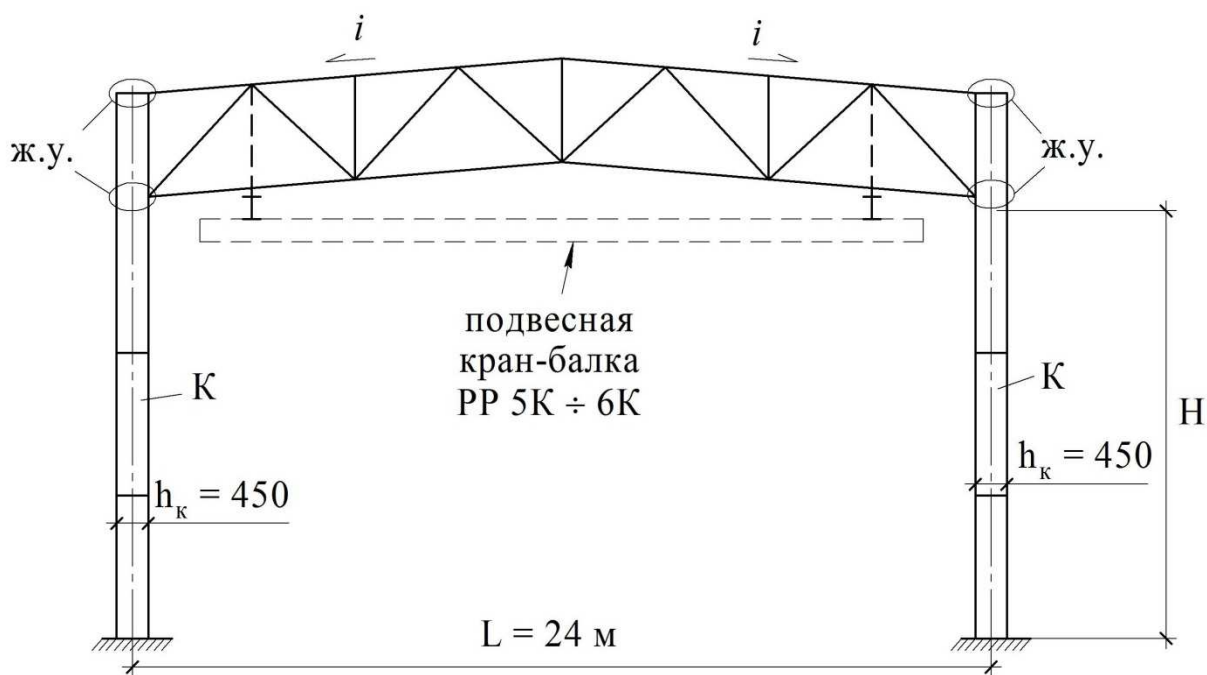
Однопролетная поперечная рама с верхними жесткими узлами и подвесными кранами-балками с колоннами постоянного сечения
